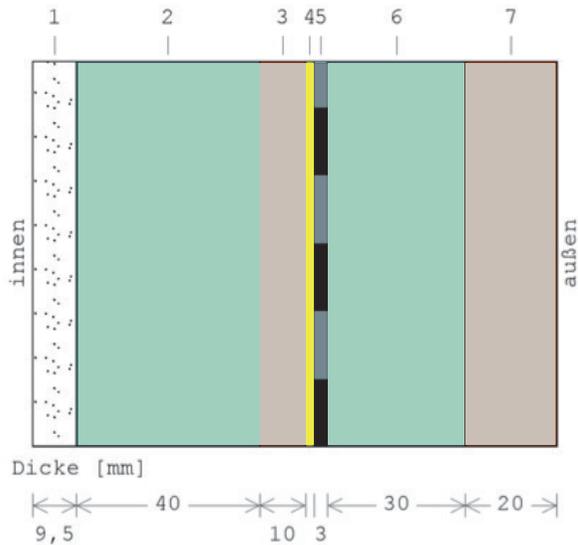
Aufbau oberste Geschossdecke mit Dämmung / Schema und Tabelle
